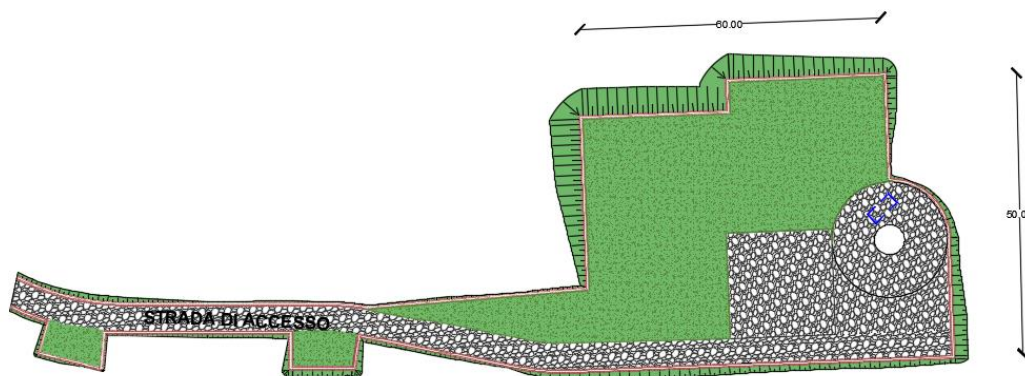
Planimetria piazzola tipo in fase di esercizio
